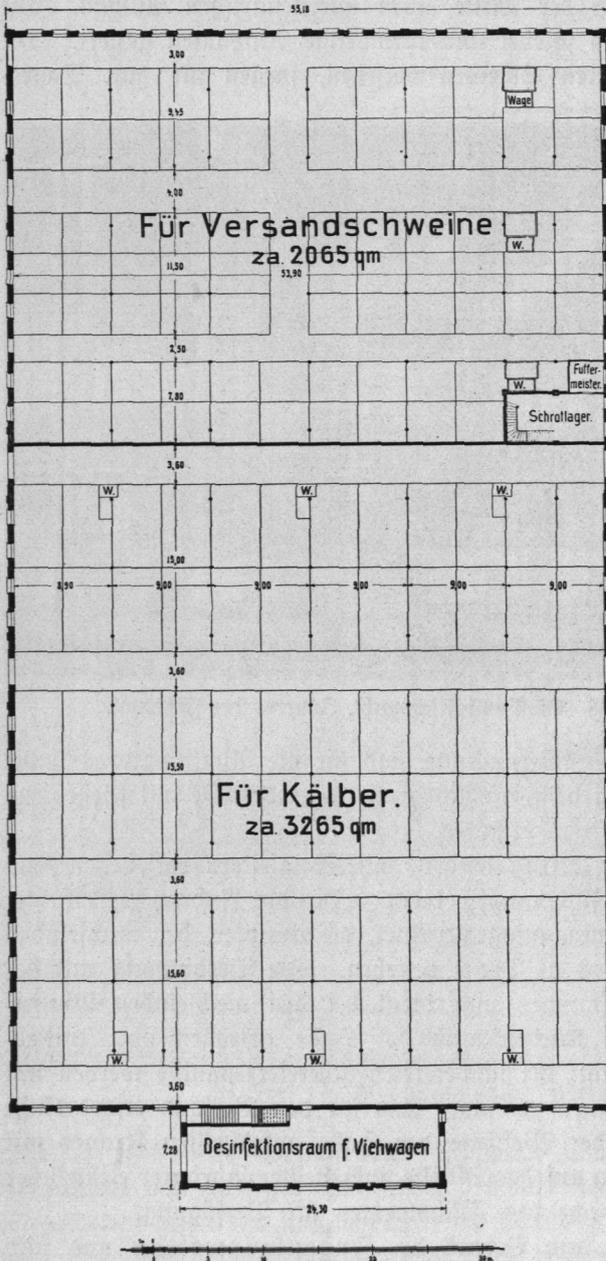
Viehhof Sternschanze, Viehverkaufshalle, Grundriß. 5490 qm Grundfläche gebaut. (Abb. 389.)
